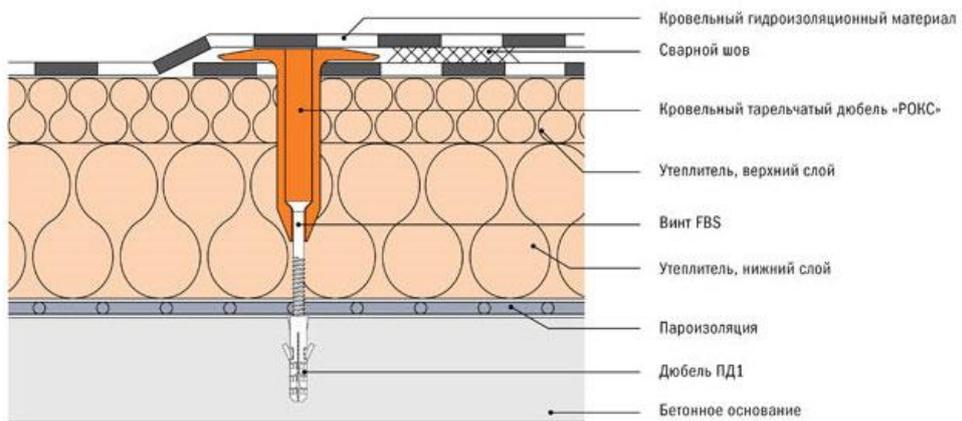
Узел механического крепления плоской кровли с бетонным основанием
